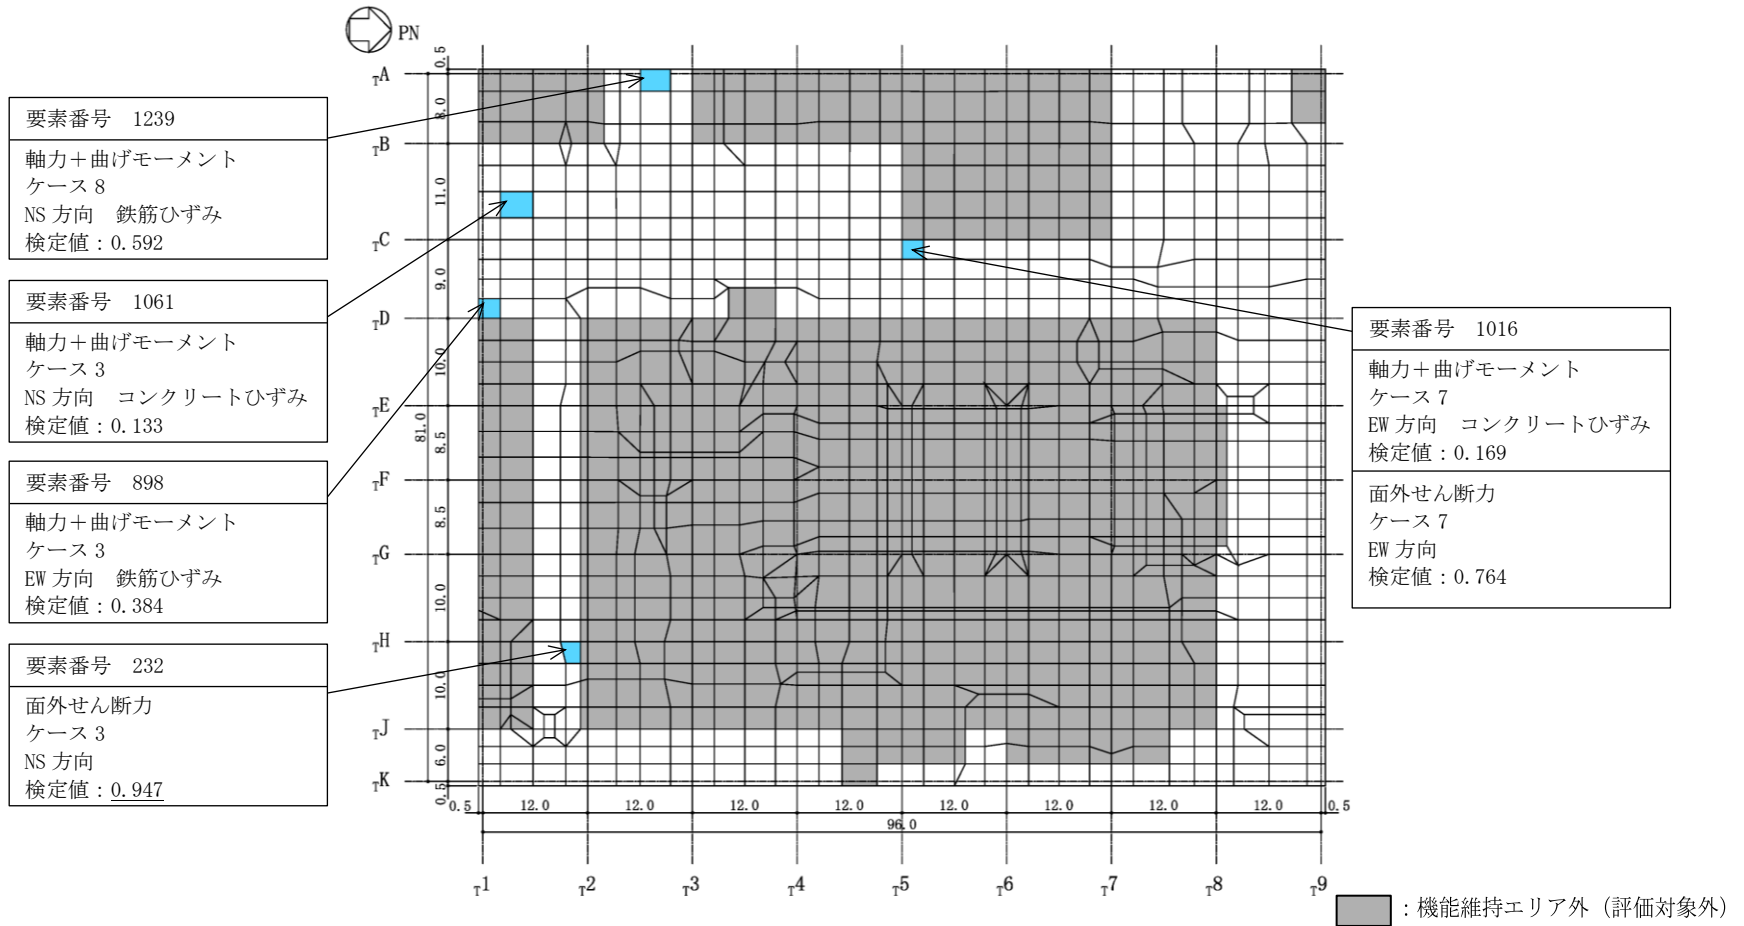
基礎スラブの配筋領域図 (せん断補強筋) (単位 : m)
